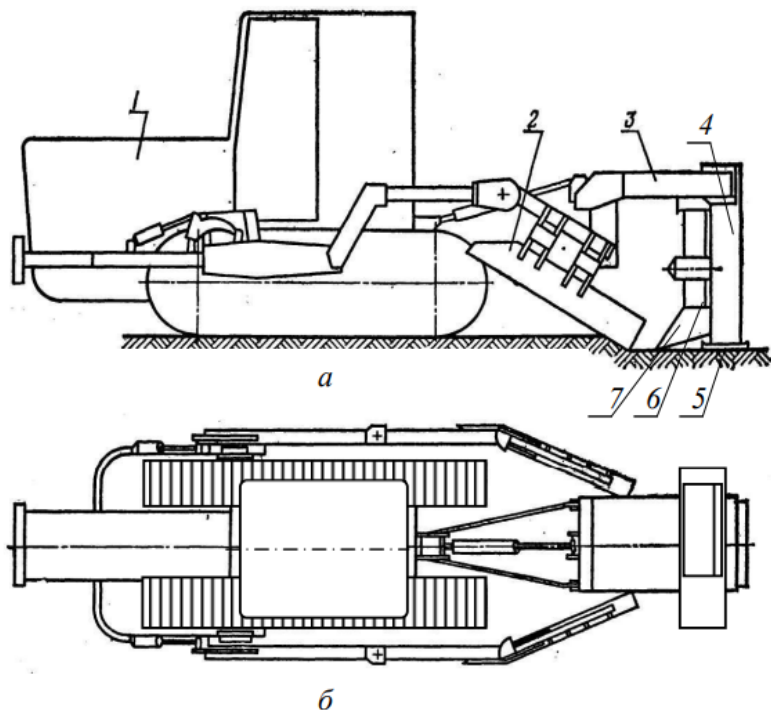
Схема отвально-фрезерного каналочистителя: а – вид сбоку; б – вид сверху.
